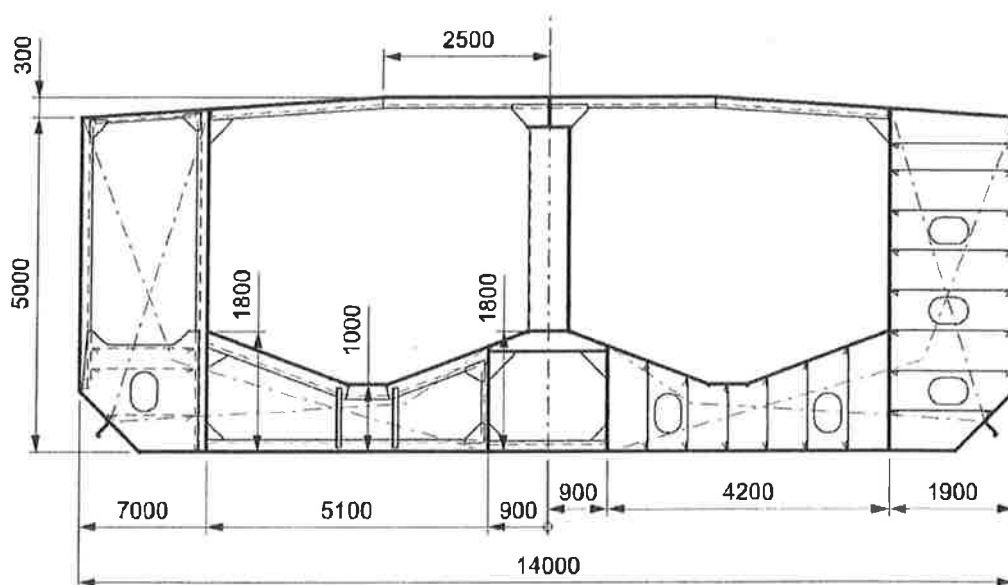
SEZIONE TRASVERSALE MEZZO NELLA ZONA DEL CARICO
